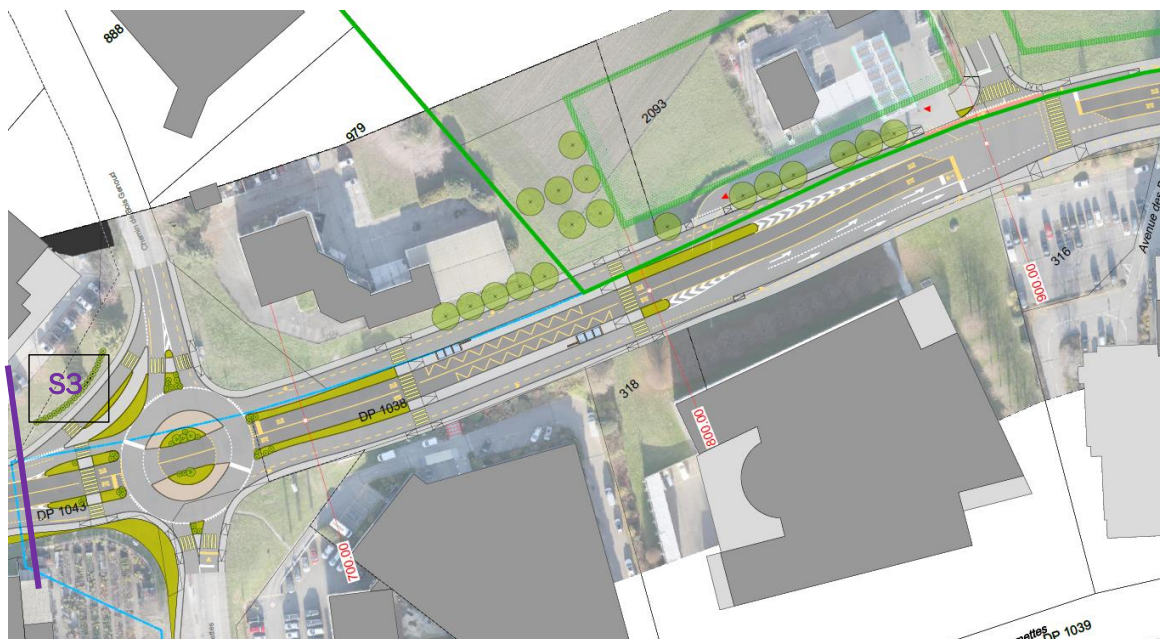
Giratoire de Bois-Genoud, arrêt de Bois-Genoud et accès Ley-Outre (km 0.500 à 1.000)
